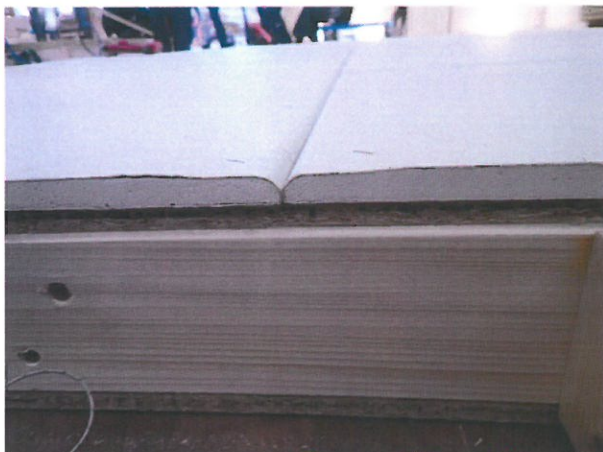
Seitenansicht der Konstruktion mit Variokante der Feuerschutzplatten.
